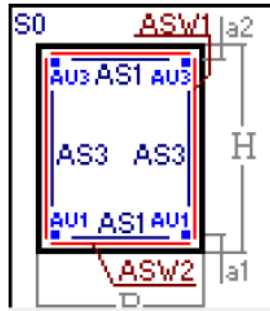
Схема розташування поздовжньої та поперечної арматури в колонах.
